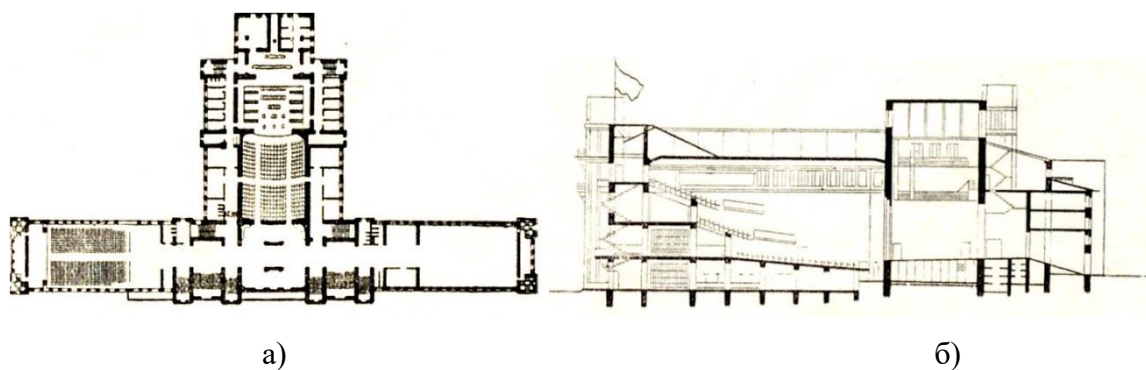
Дворец труда в городе Надеждинске (Серове). а) План 2-го этажа, б) разрез.
